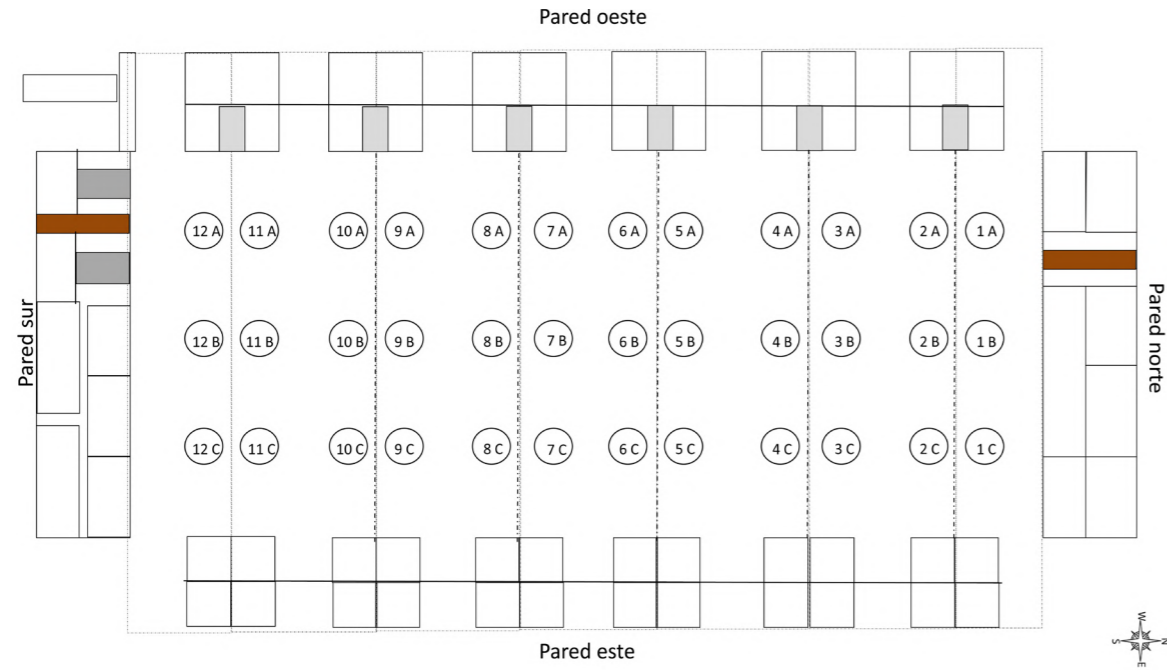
Plano de la segunda sala hipóstila (elaborado por la autora).
